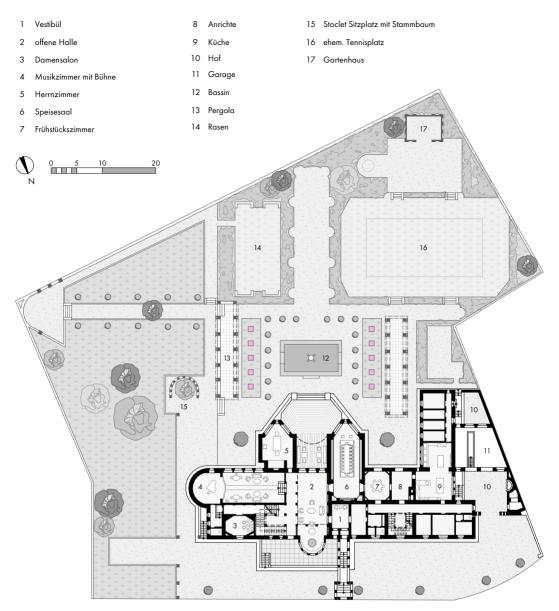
Gartenanlage mit Grundriss Erdgeschoß, Übersichtsplan.
